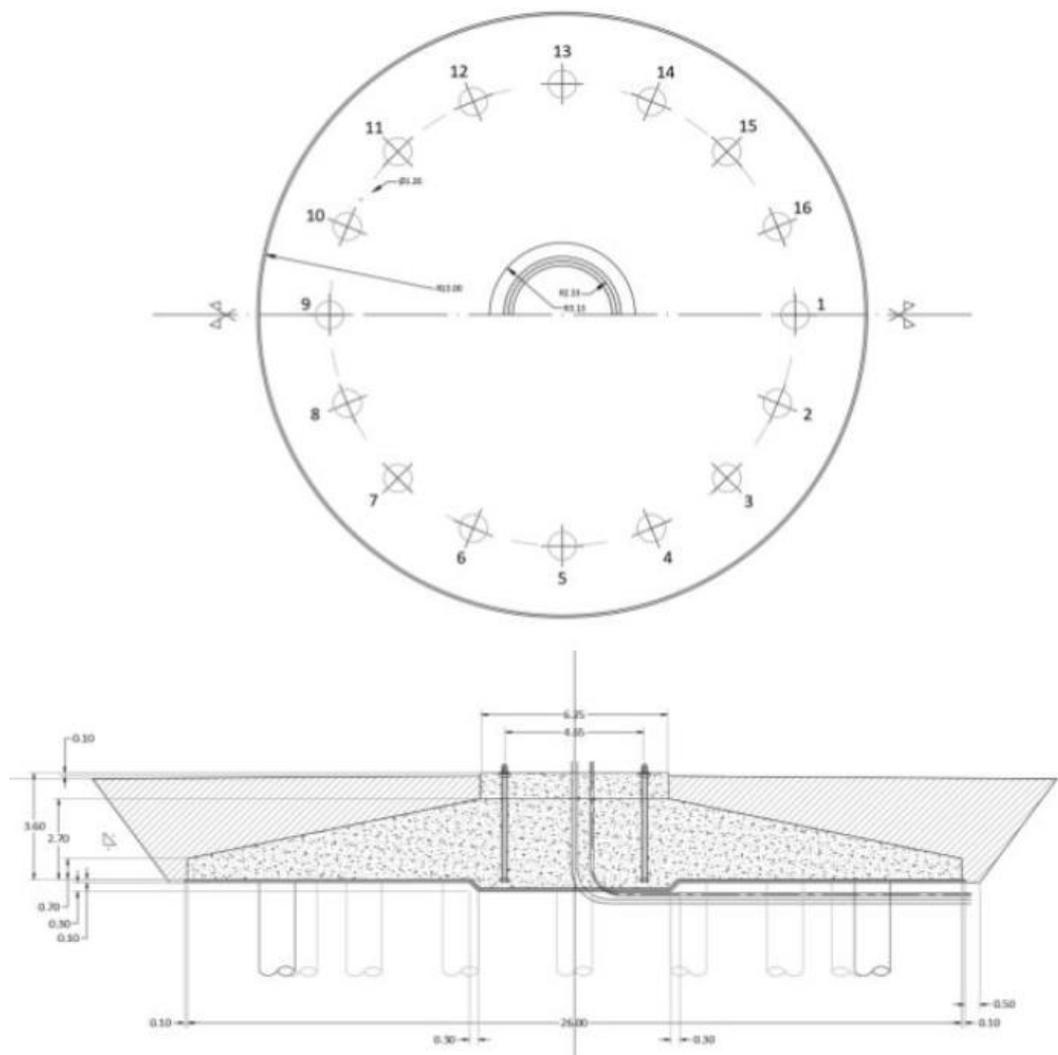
Tipologico fondazione aerogeneratore: pianta e sezione
